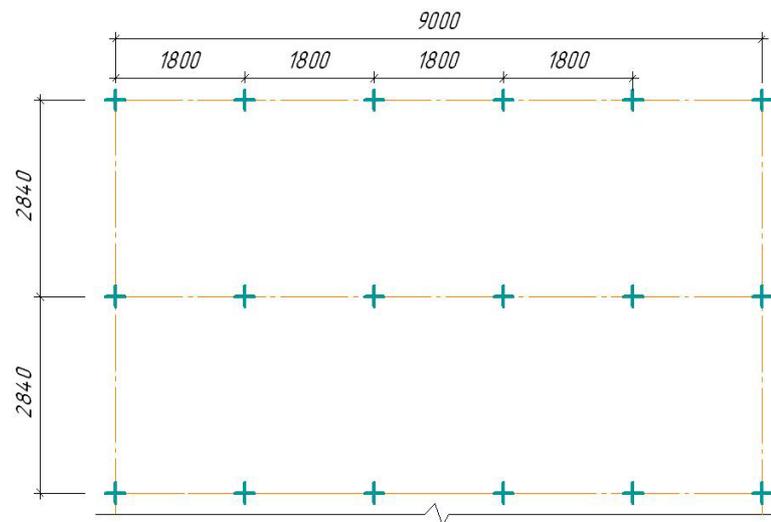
Схема плана свайного поля под модульное здание длиной 9 м
